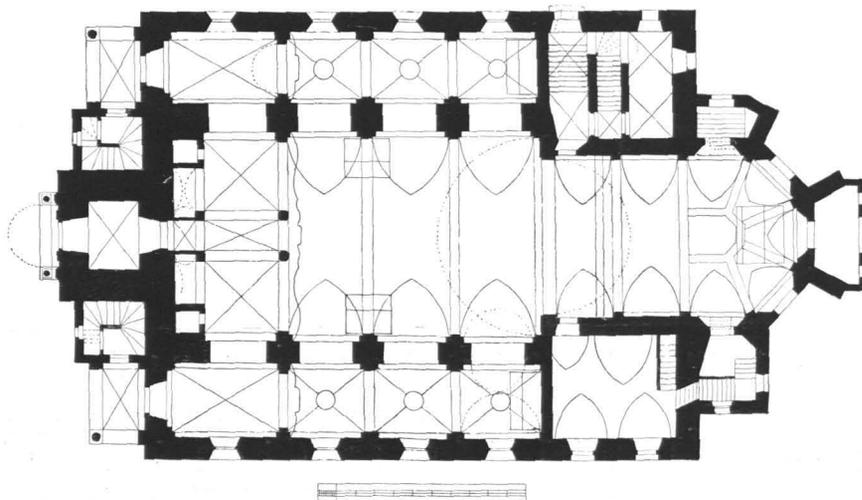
Seekirchen, Stiftskirche, Grundriß 1 : 400 (S. 131)
